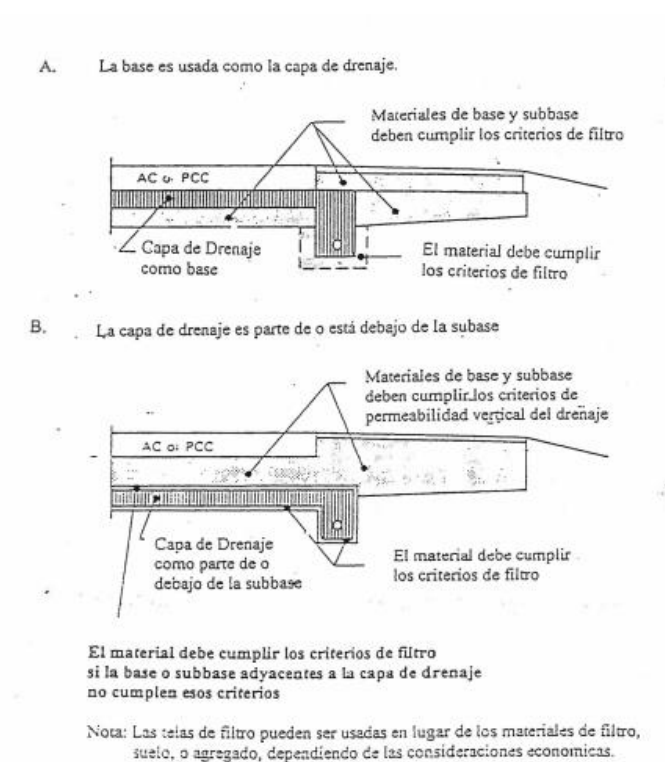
Ejemplo de capa de drenaje en una estructura de pavimento
